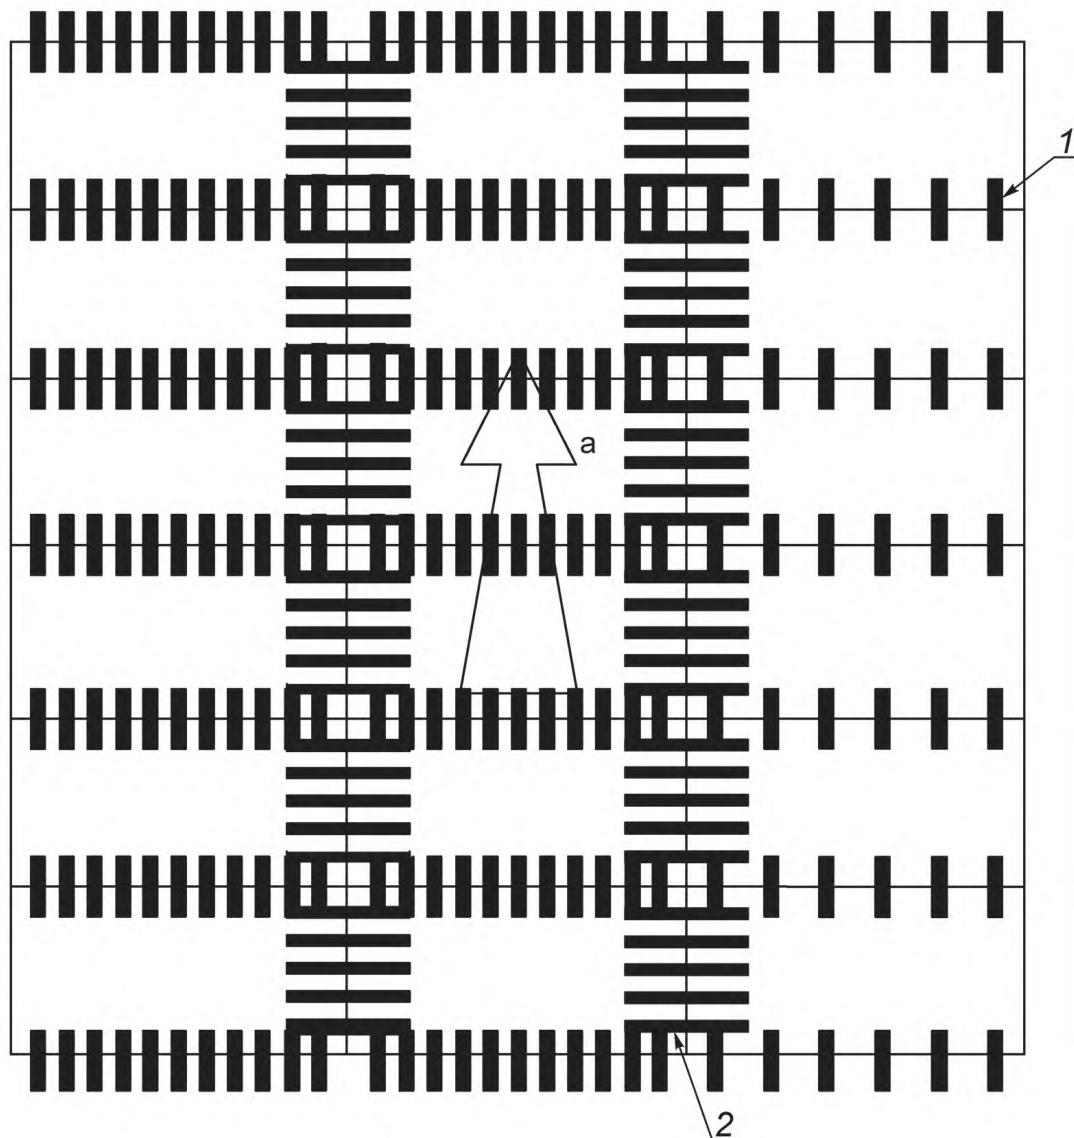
Механизм для укладки продольных стягивающих арматурных стержней:
